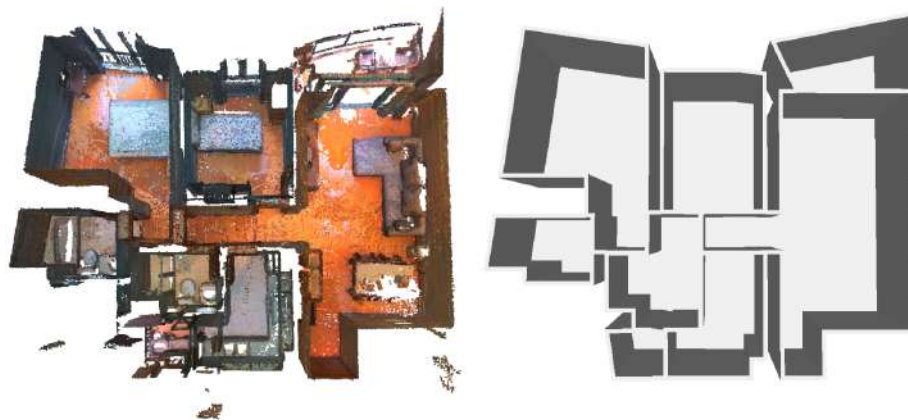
：我们方法的目标。左：算法从作为输入数据的原始点云出发。右图：室内场景的平面图被重建为平面图，其中每个简单的循环代表房间的多边形边界。请注意，将 2D 平面图转换为 3D CAD 模型以进行可视化。
